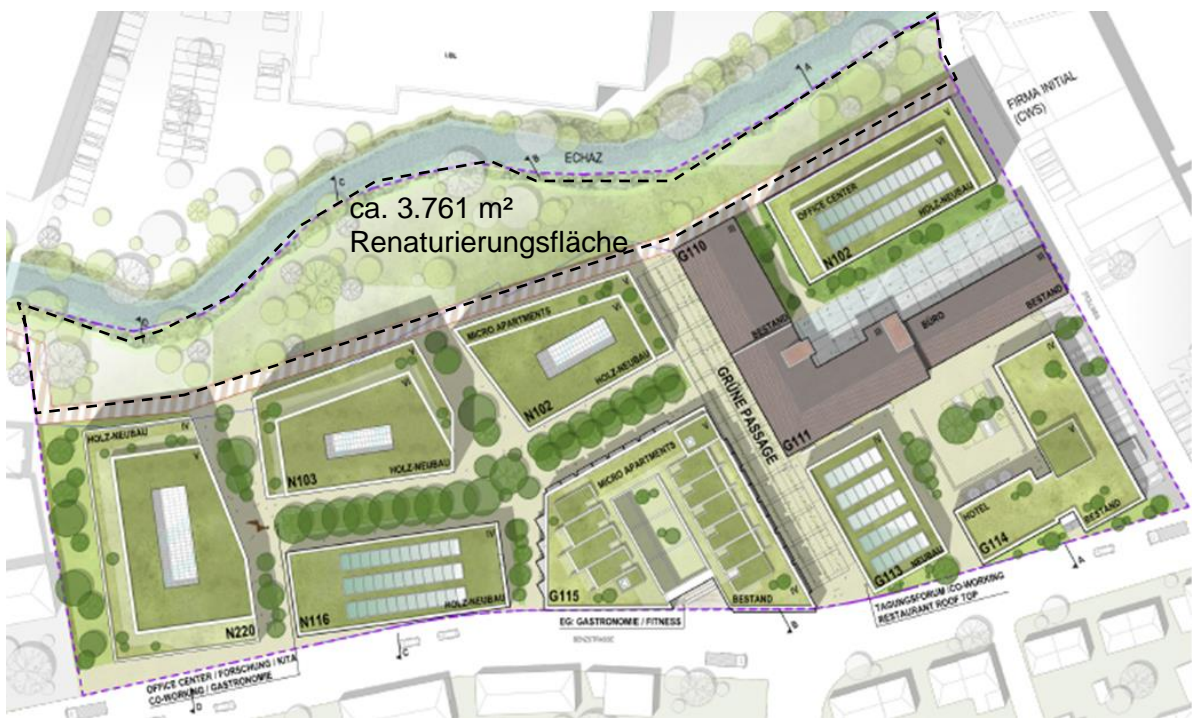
Lageplan von TRIAS mit Renaturierungsfläche
